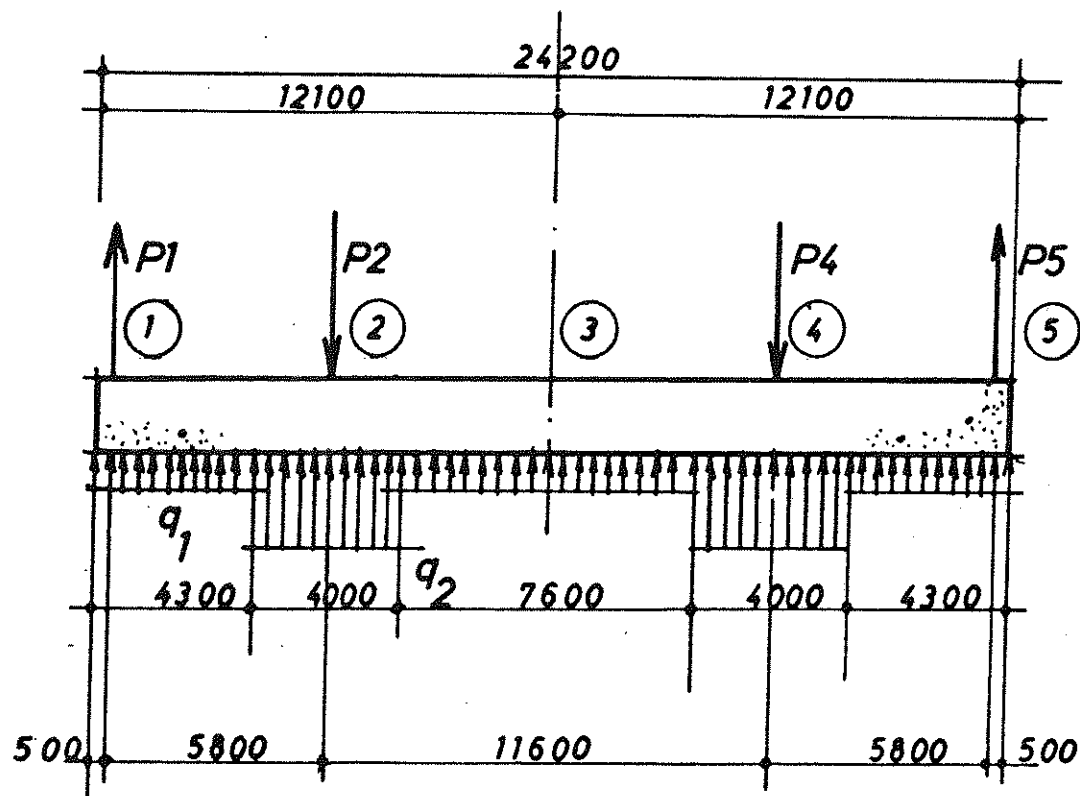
Trave di fondazione lato ospedale: schema di calcolo
